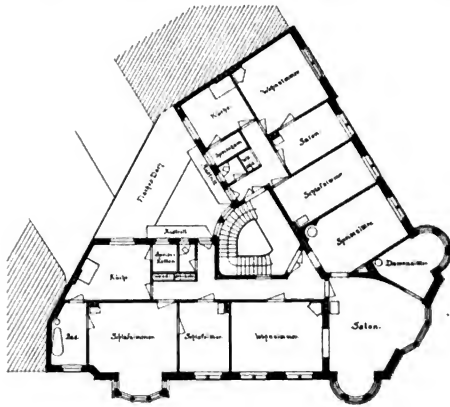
u. 387. Sparkasse vor dem Steinthor. Grundriß der beiden Hauptgeschosse.
